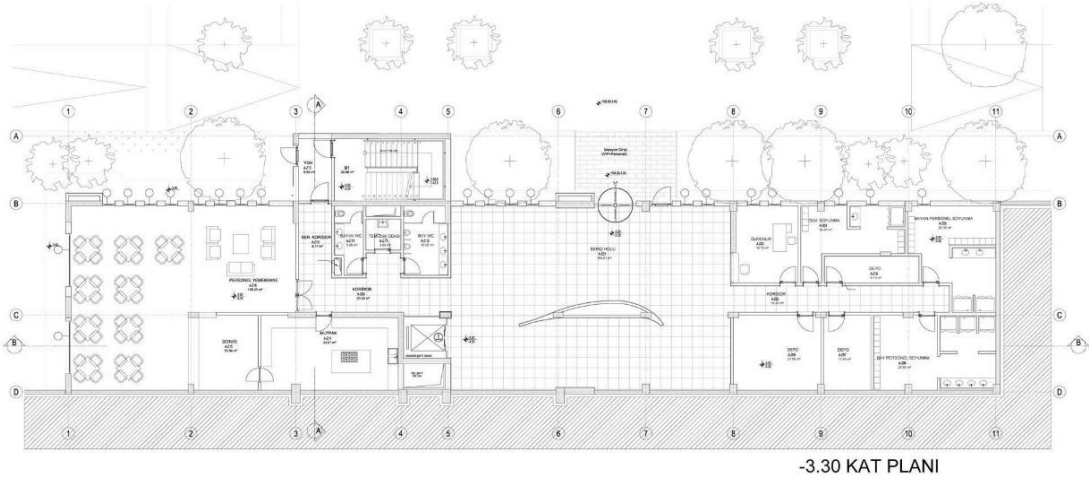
Bozüyük istasyonu A blok zemin kat planı ve vaziyet planı (İtez, 2015)
